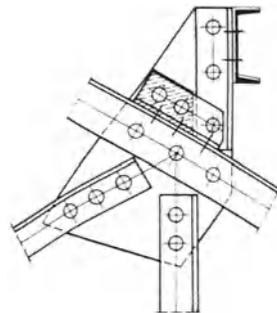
Knotenpunkt mit senkrechter Pfette.
